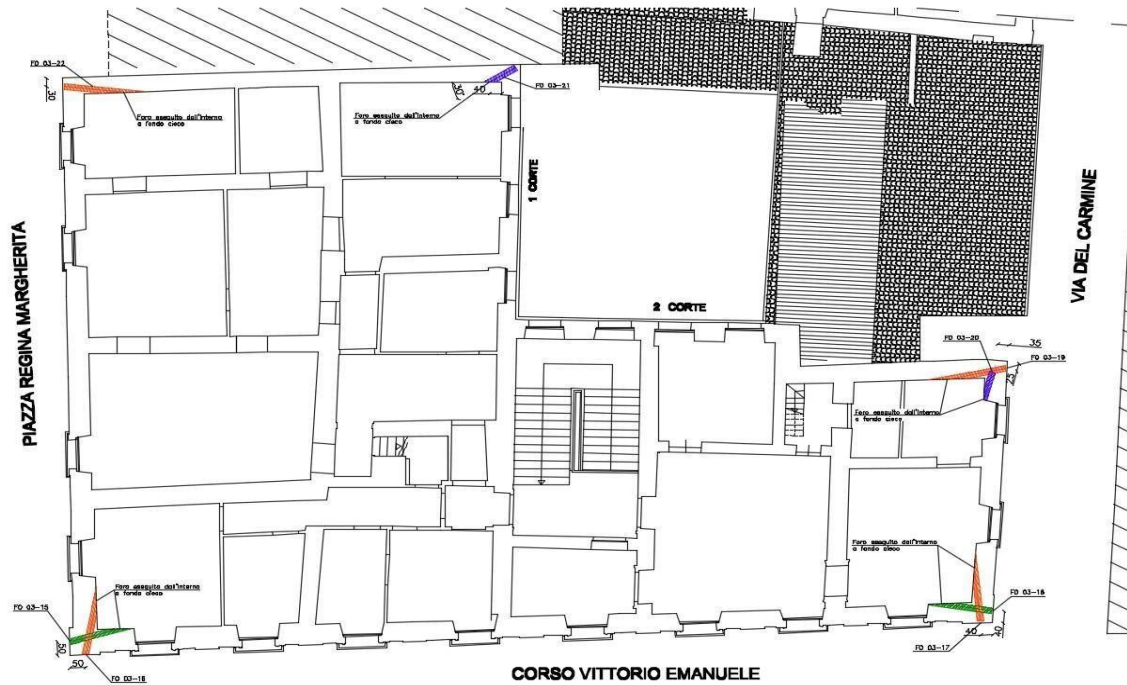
PIANTA PIANO SECONDO - POSIZIONE SENSORI SUI MASCHI MURARI DEL 3° ORDINE MONITORATI
